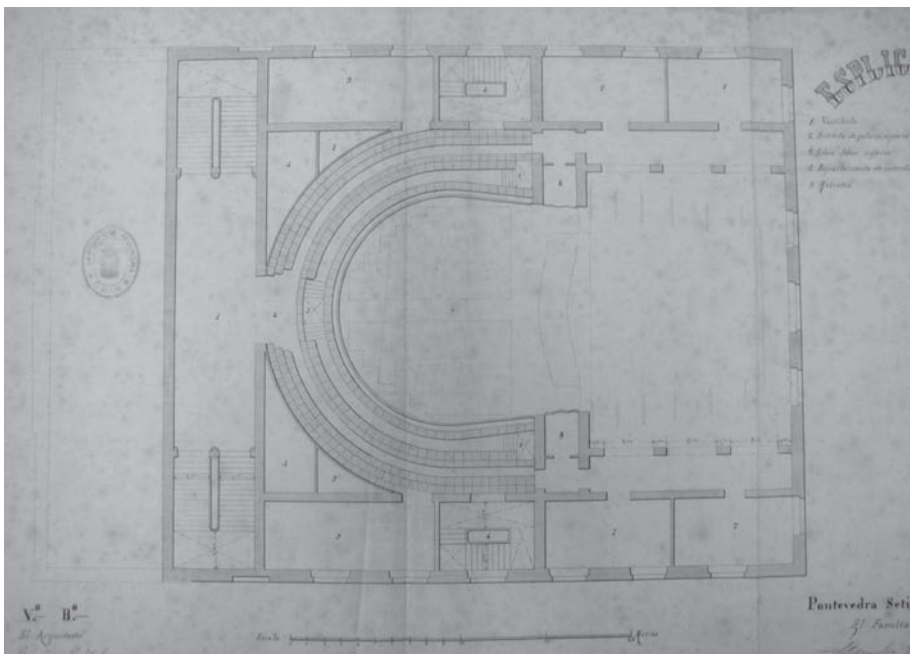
Proyecto del Teatro Cervantes o Rosalía. Planta principal. A.R. Sesmero. 1881.
